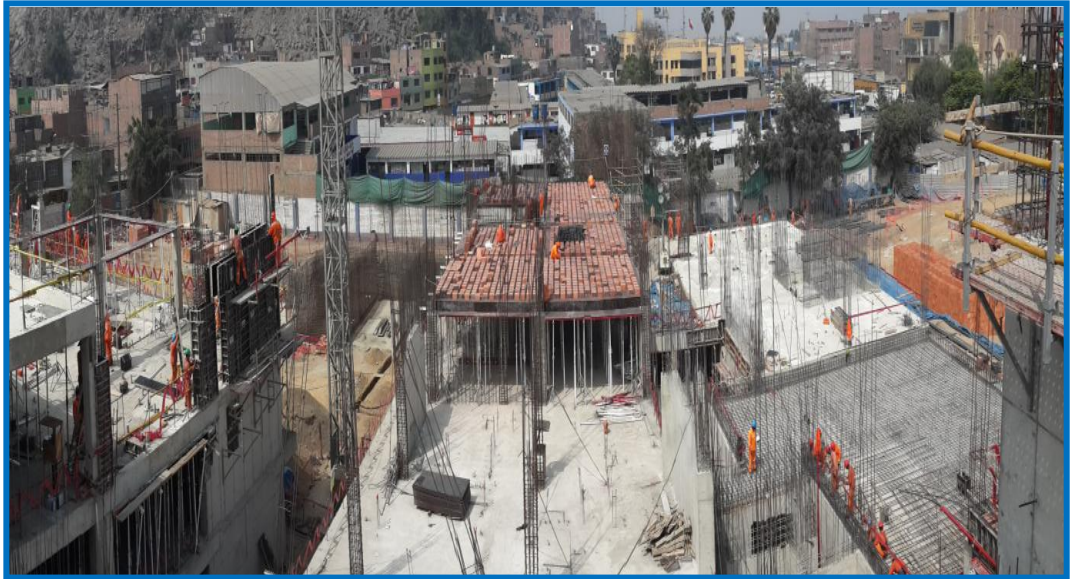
Colocación del acero corrugado en platea y vigas de cimentación pertenecientes al Sector C1.
